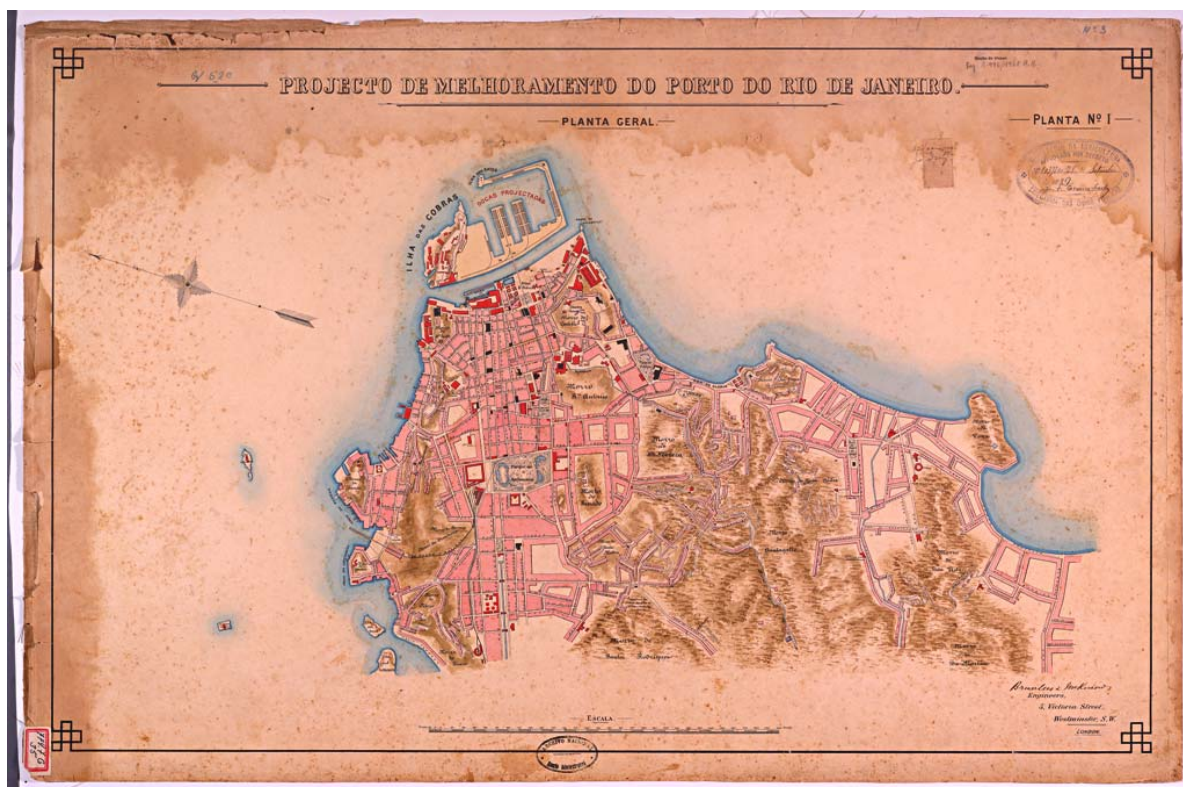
Porto do Rio de Janeiro – Planta Nº. 1
